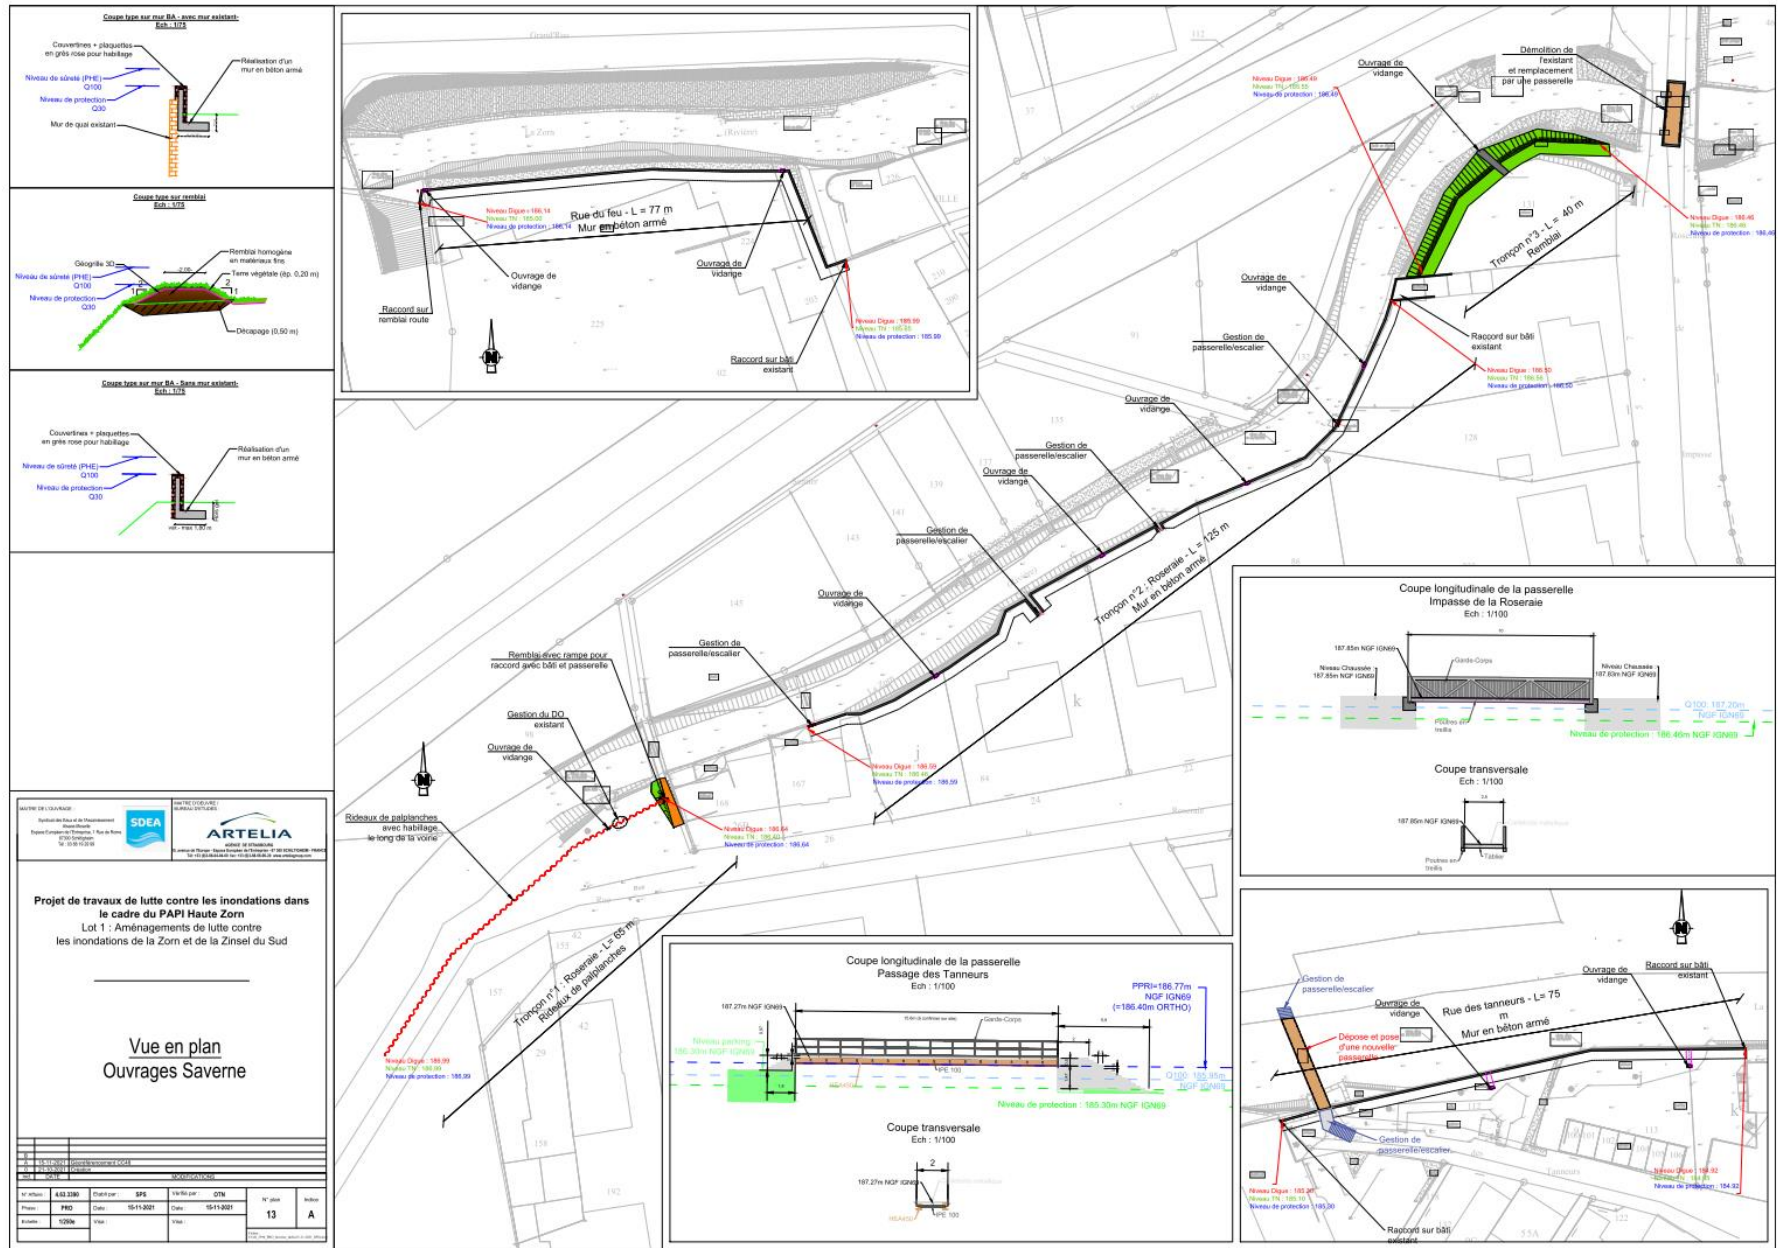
Plan PRO du système d'endiguement de Saverne, ARTELIA 2022
